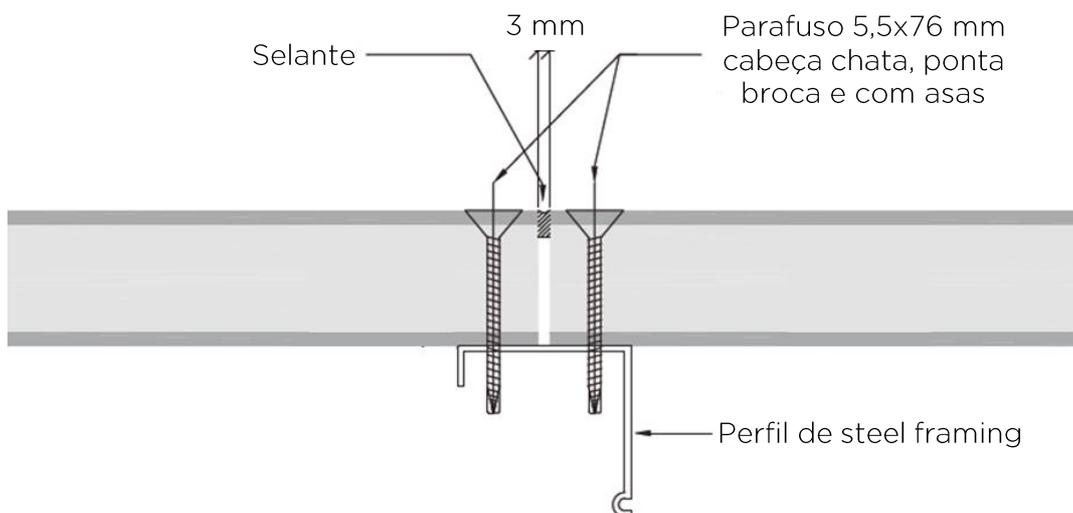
Detalhe de fixação do Painel Masterboard Brasilit sobre perfil de LSF.
